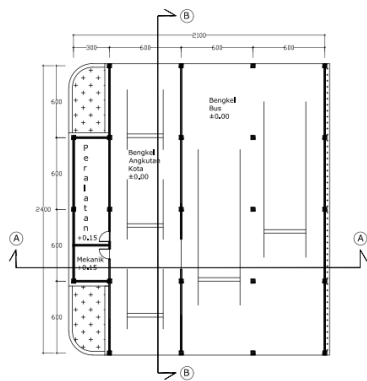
Pengembangan Massa Rancang Bangun Terminal
